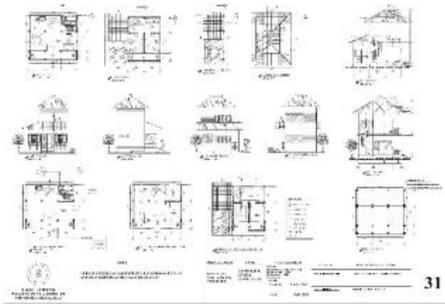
Potongan, Tampak dan rencana pondasi
